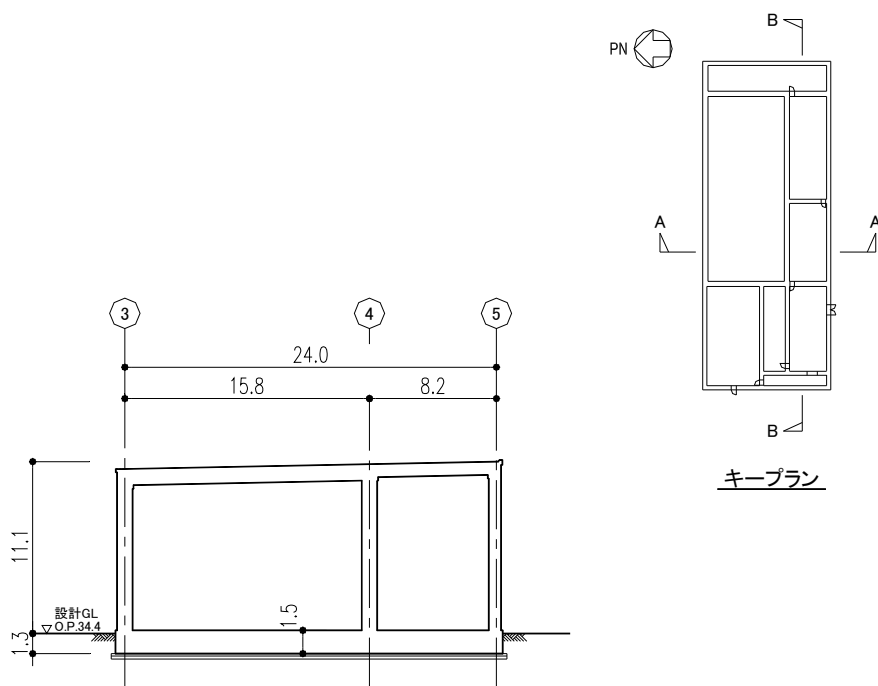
スラッジ棟 A-A断面図 (NS 方向) (単位：m)
